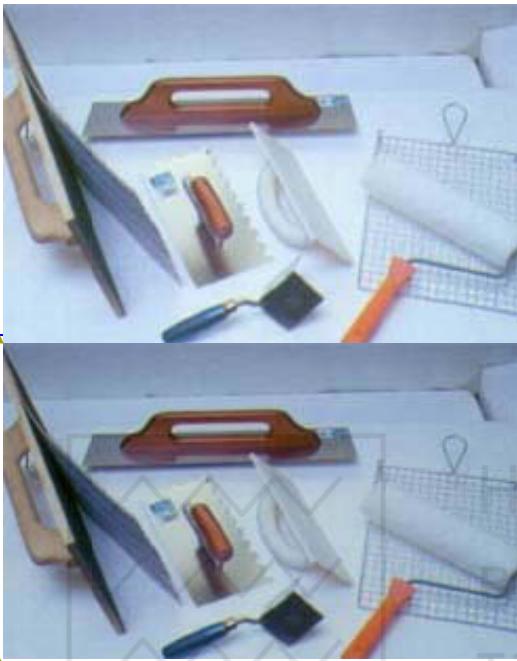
Інструмент для підготовки поверхні до фарбування
